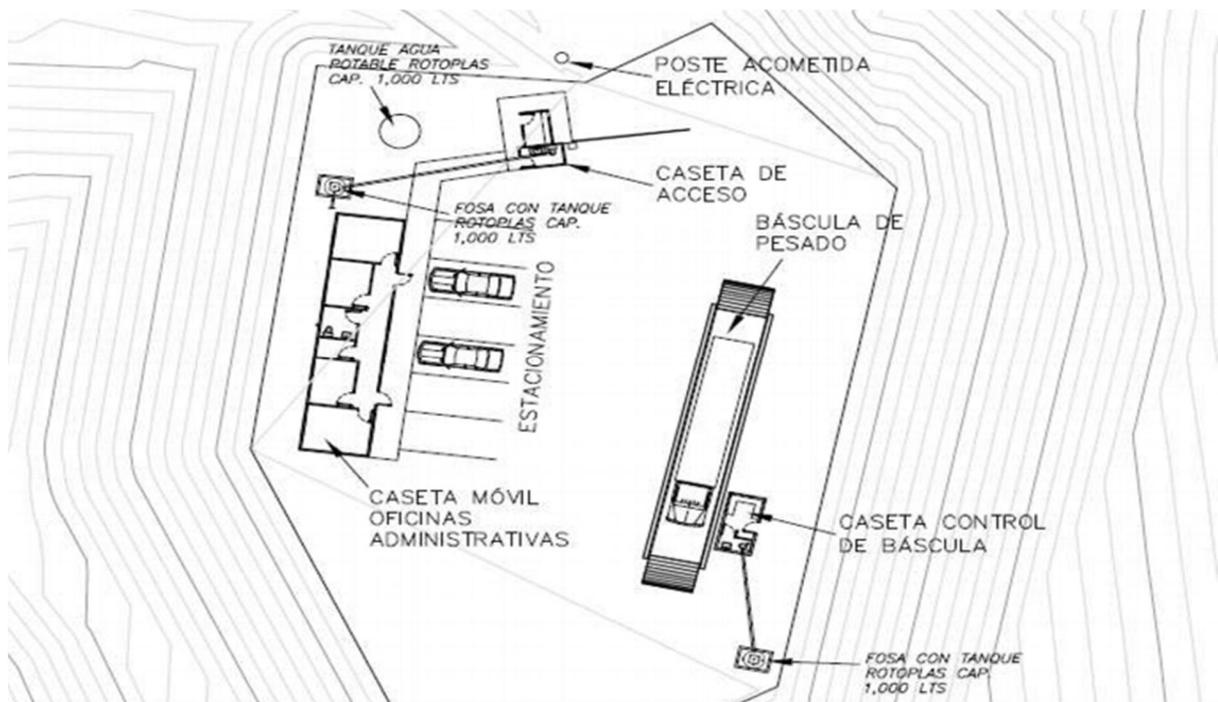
Imagen ejemplo de la planta de conjunto de áreas de equipamiento
